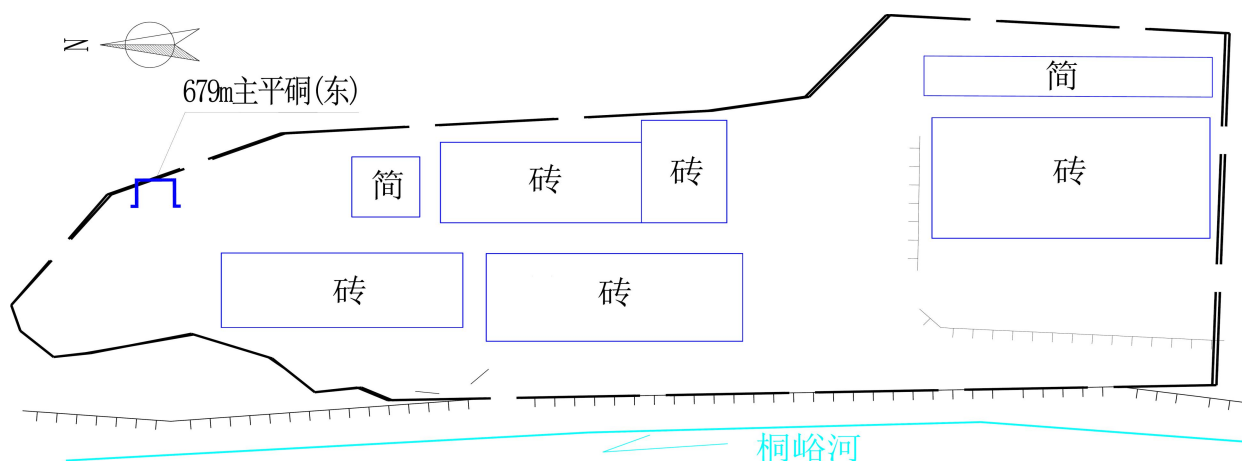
679 主平硐（东）及工业场地平面布置图
